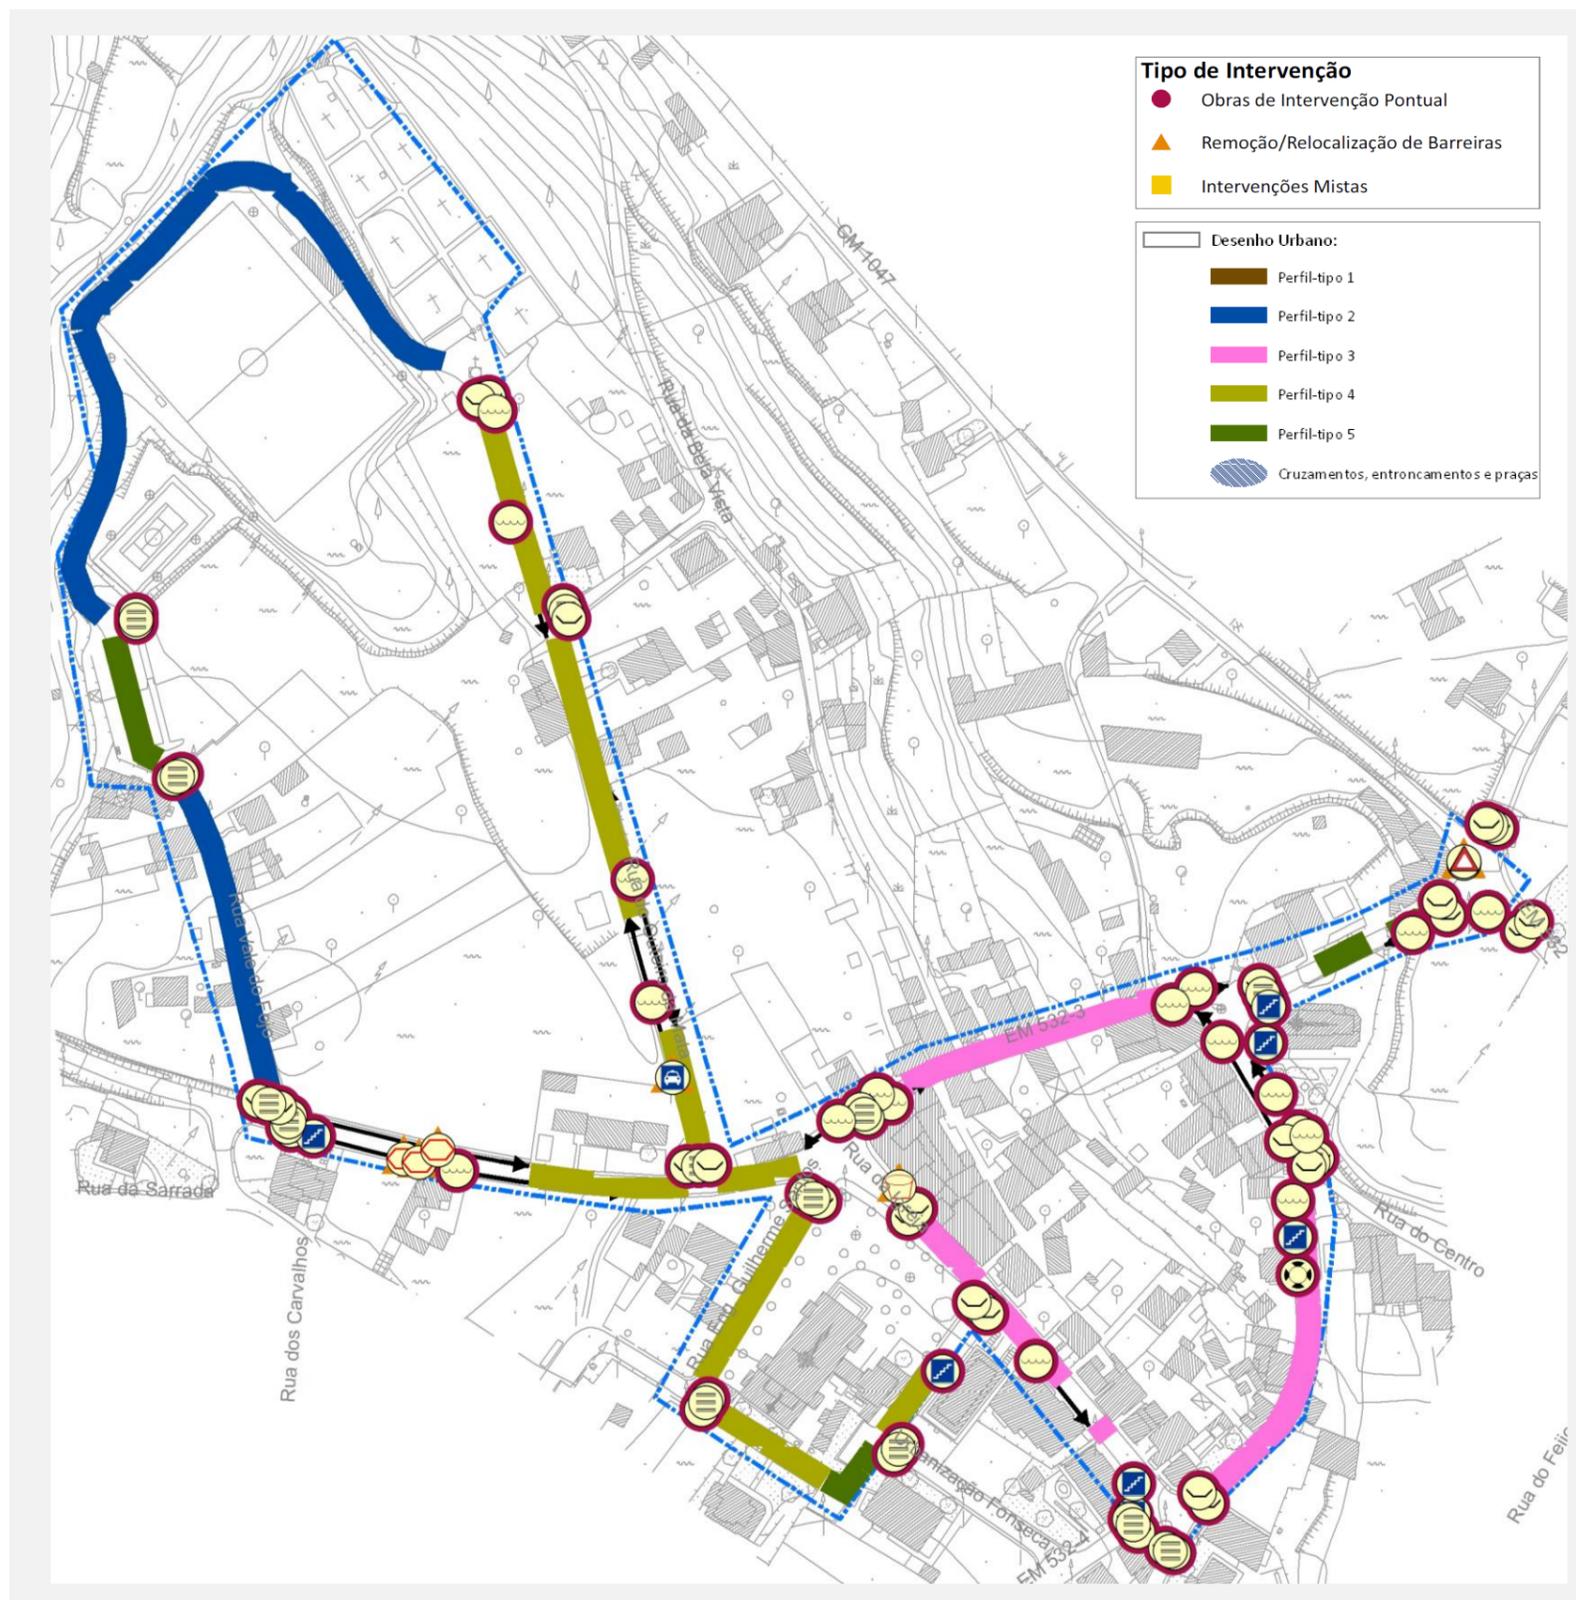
Extrato de Planta de Tipologias de Intervenção – Planta Síntese.
